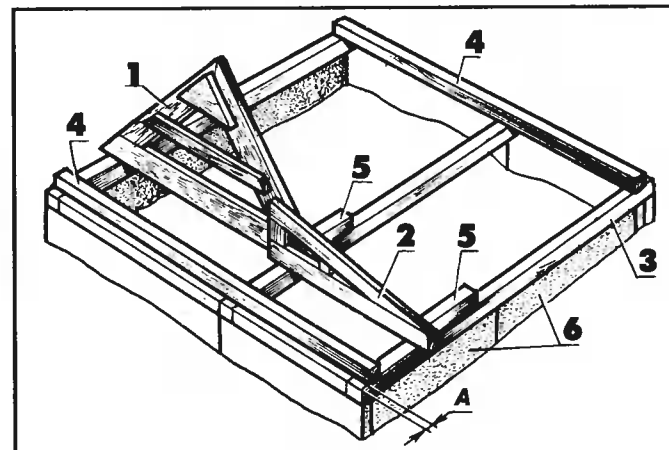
Монтаж деталей крыши: 1 – ферма комнаты; 2 – ферма веранды; 3 – верхняя обвязка; 4 – бруски для крепления фронтонов и потолка; 5 – бруски для крепления ферм веранды и комнаты; 6 – панели; А – толщина досок каркаса фронтонов
